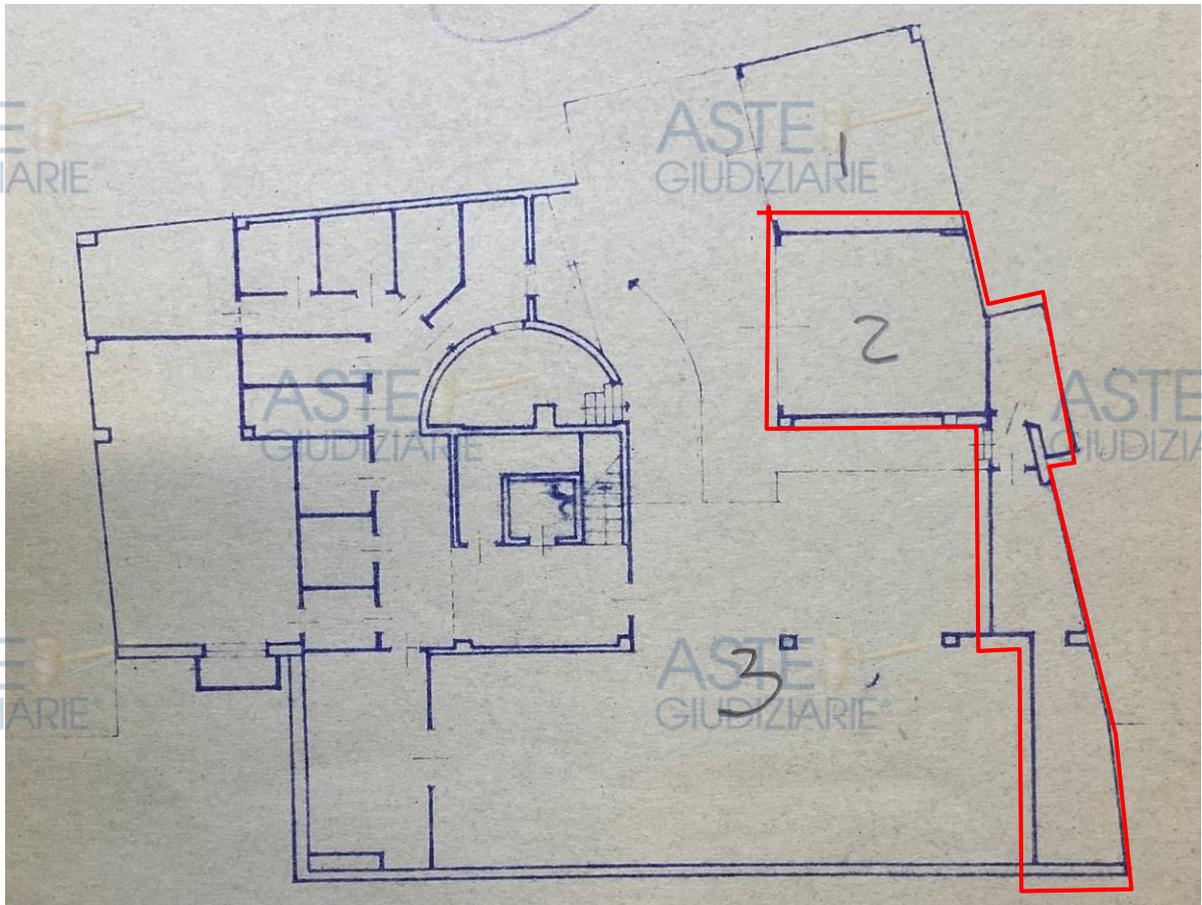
Estratto pianta di progetto di variante Prot. Gen. 13711/1967 Prot. U.T. 2161 del 17.05.1967 -Piano interrato
